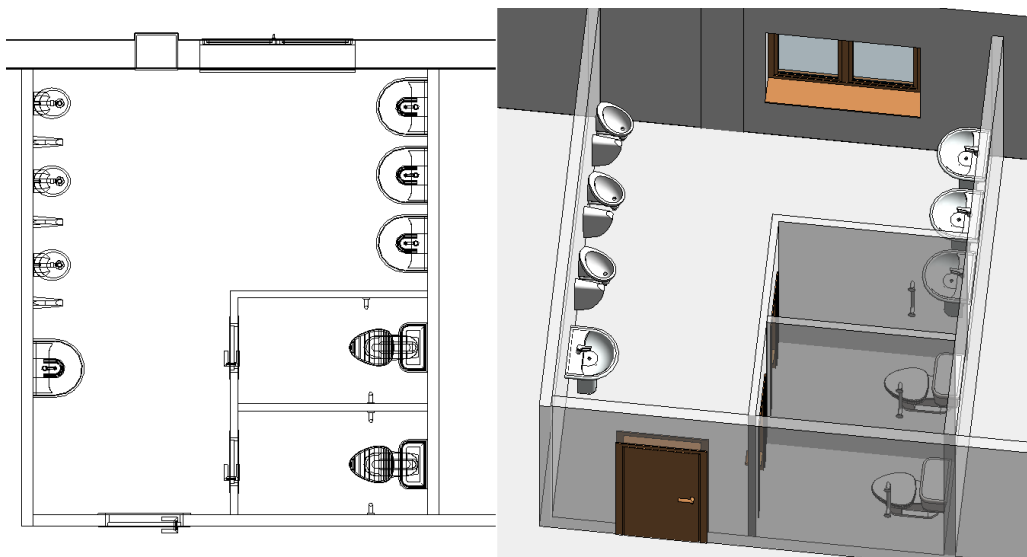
Vista en planta y vista 3D de la sala de aseo.
